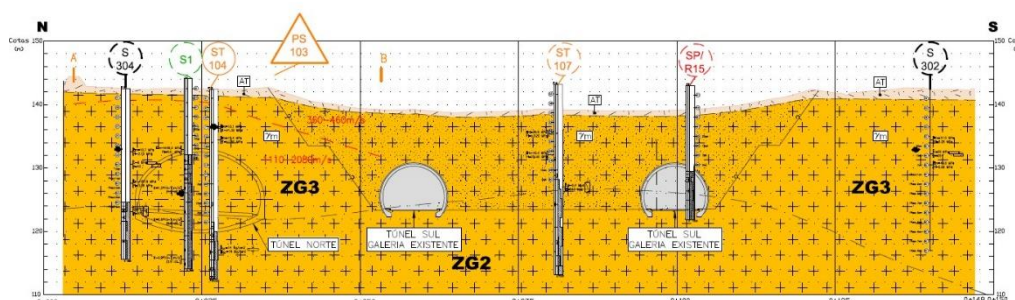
Perfil geológico transversal – Emboquilhamento Nascente
